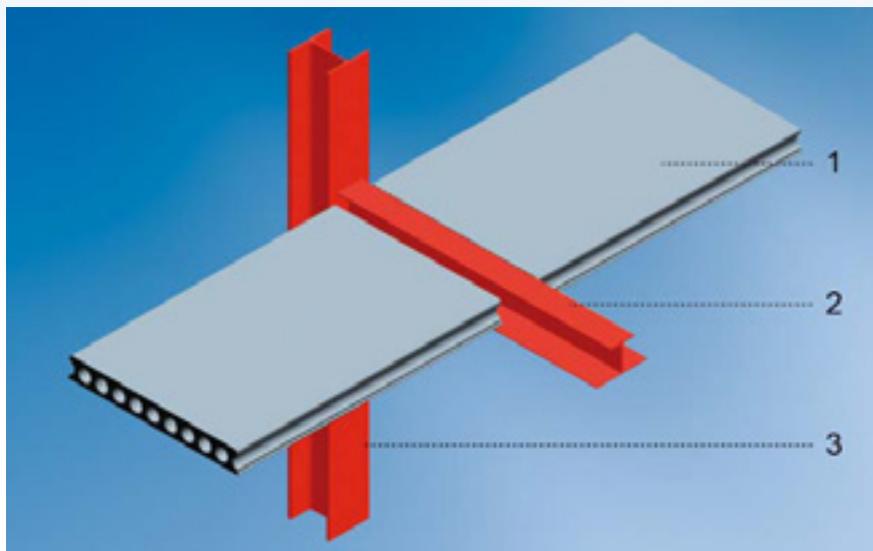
Сборные железобетонные плиты со встроенной балкой
